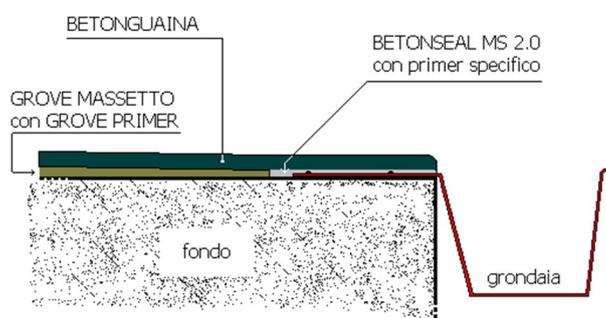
Vorbereitung des Untergrunds mit bereits angebrachten Dachrinnen und Anschlussblechen: Abdichtung und Verlegung BETONGUAINA.
